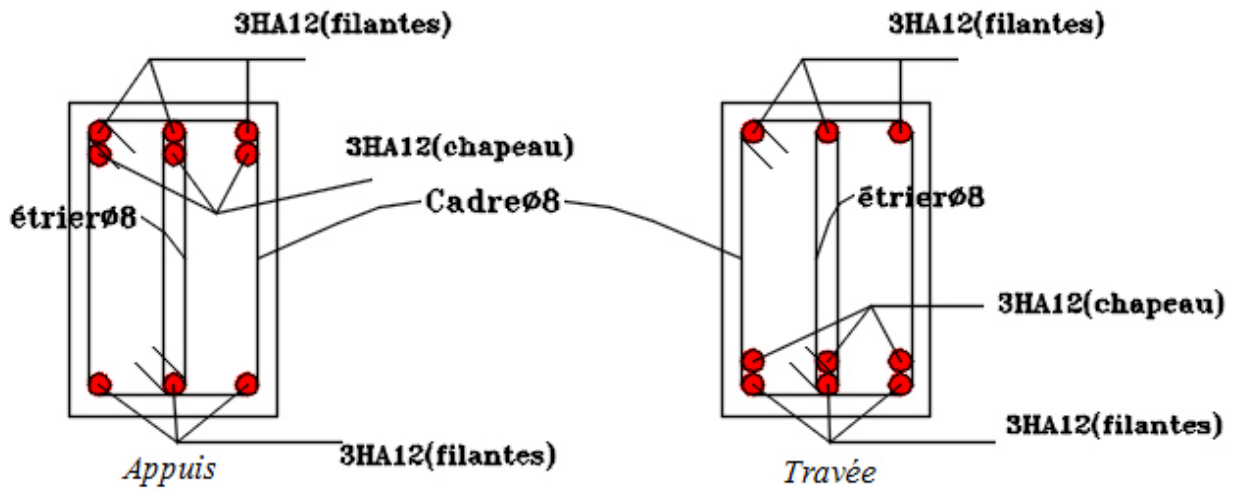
Schéma de ferrailage des poutres secondaires du RDC
